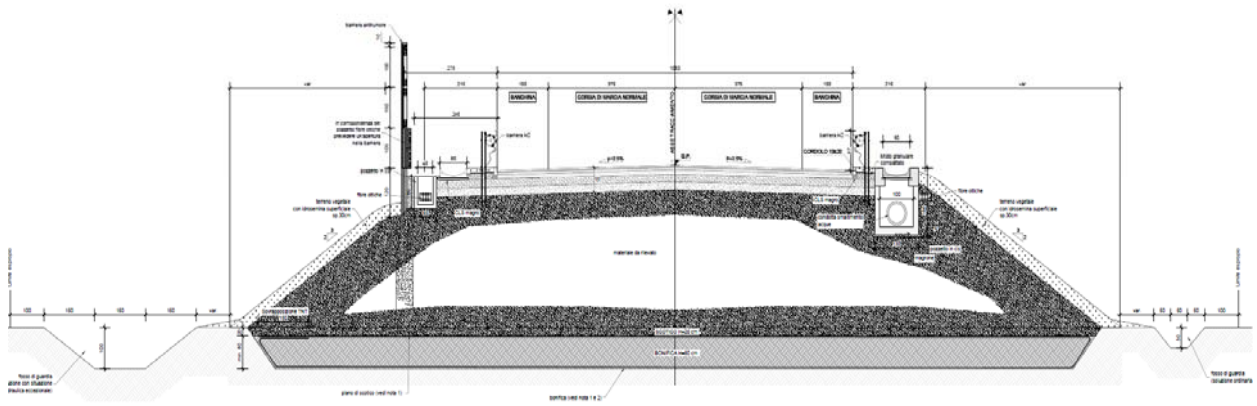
SEZIONE TIPO IN RILEVATO
